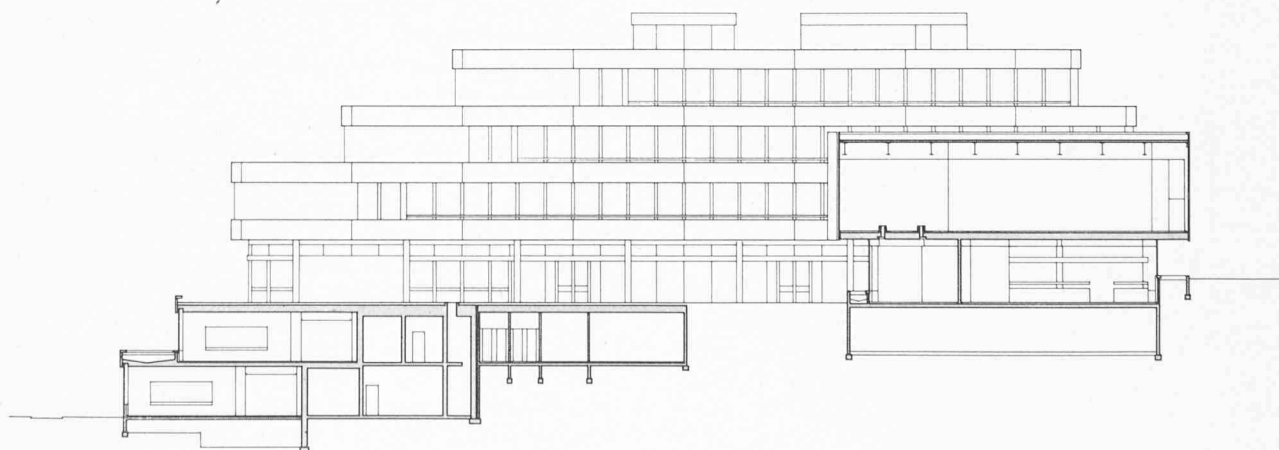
Coupe à travers l'aula et le bâtiment secondaire.
